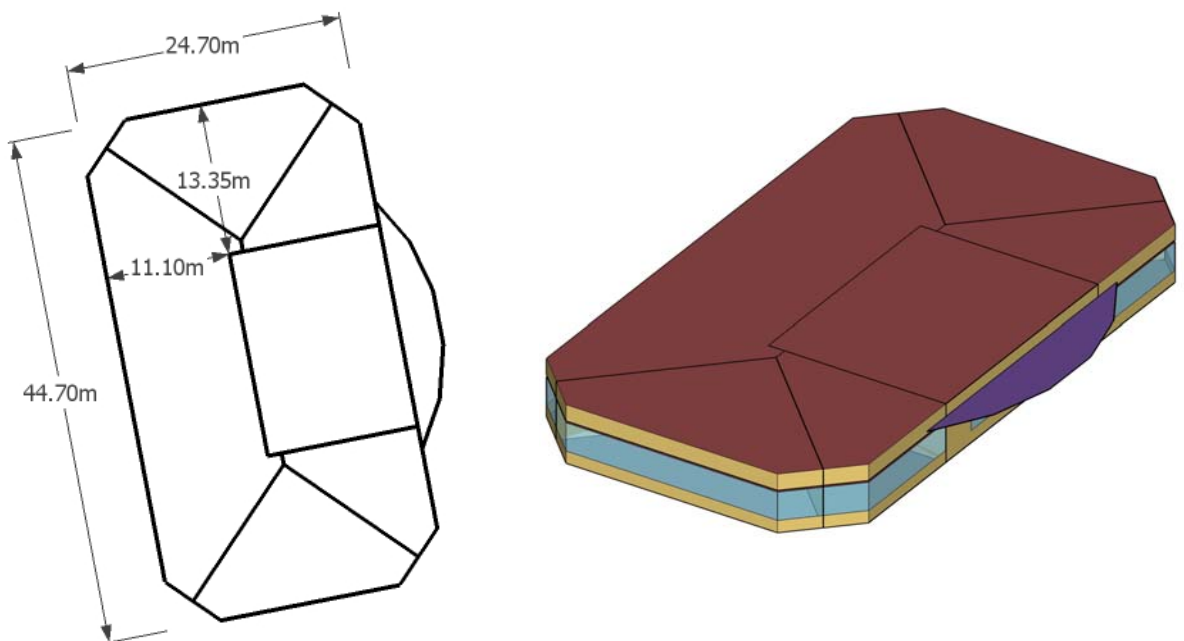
Planta e modelo espacial do Proposed Building para o estudo de caso #1
